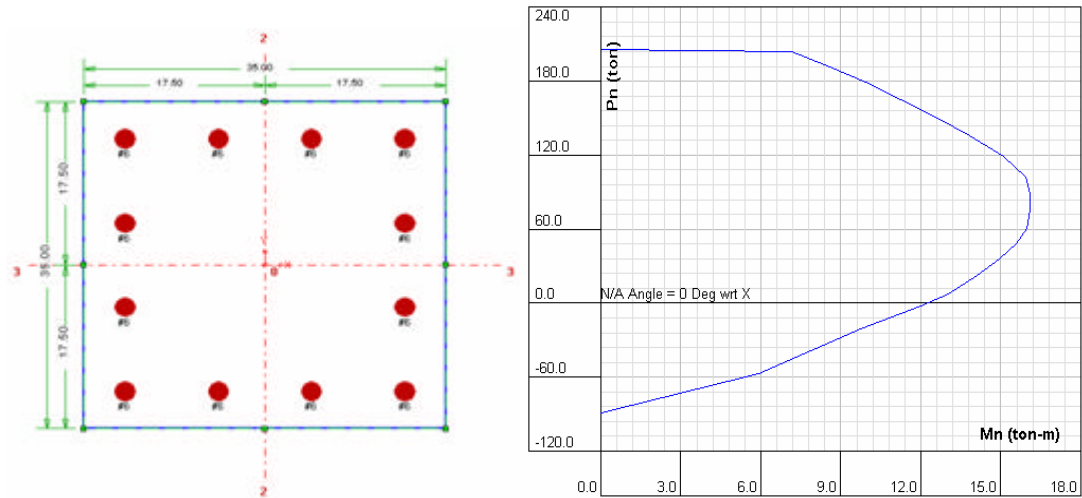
Sección transversal y diagrama de interacción para la columna tipo 1 en el primer piso.
